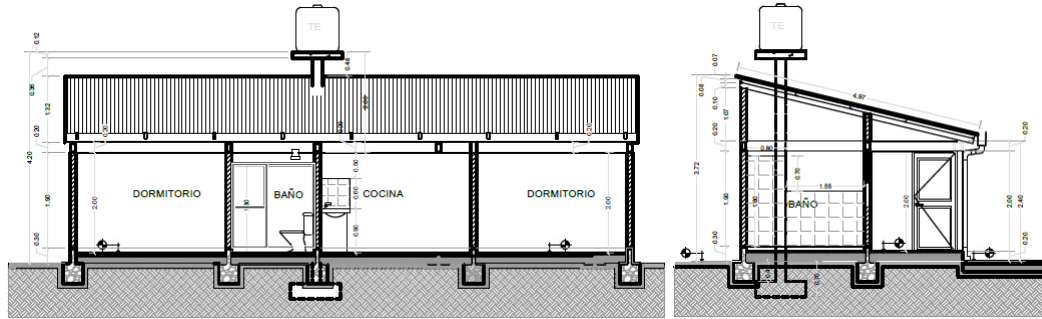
Planos Arquitectónico, Corte A – A' y Corte B – B'
